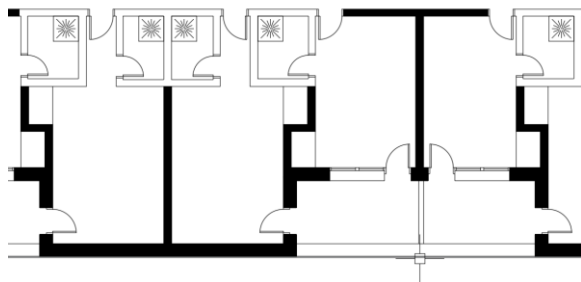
Planta primera y segunda de la edificación. Fuente: Inturjoven.com
